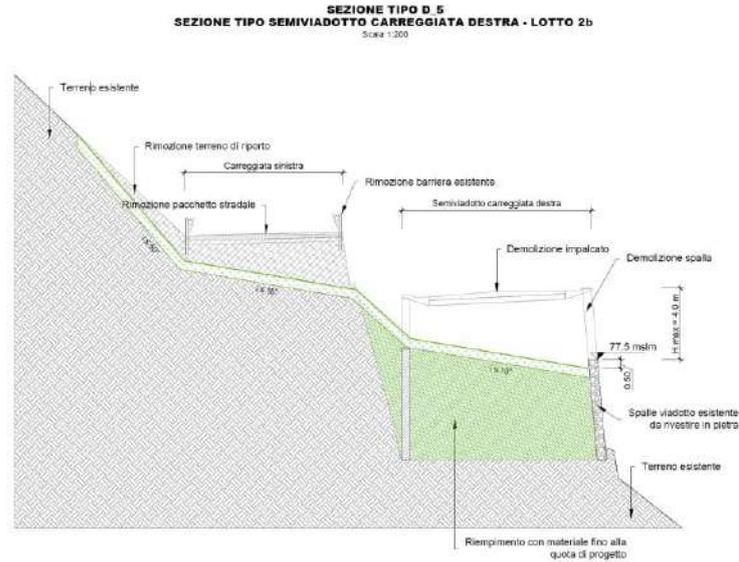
Sezione tipo D_5 semiviadotto carreggiata destra – Lotto 2b
